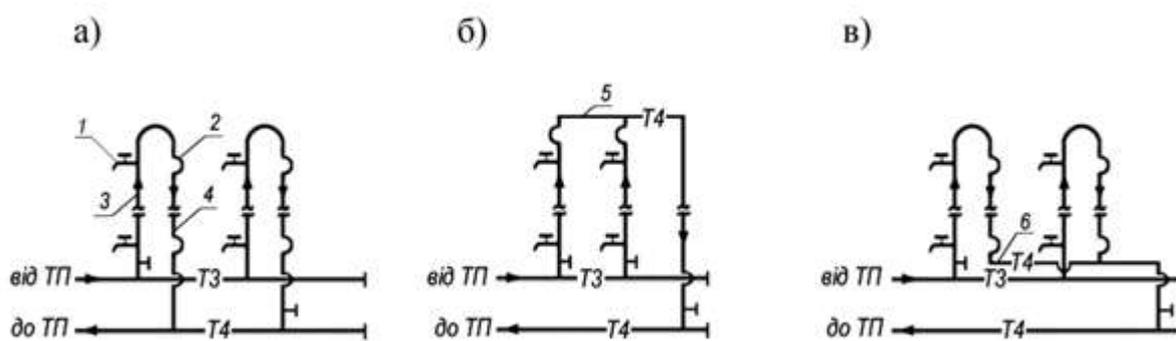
Схеми систем гарячого водопостачання житлових будівель з нижньою розводкою:
